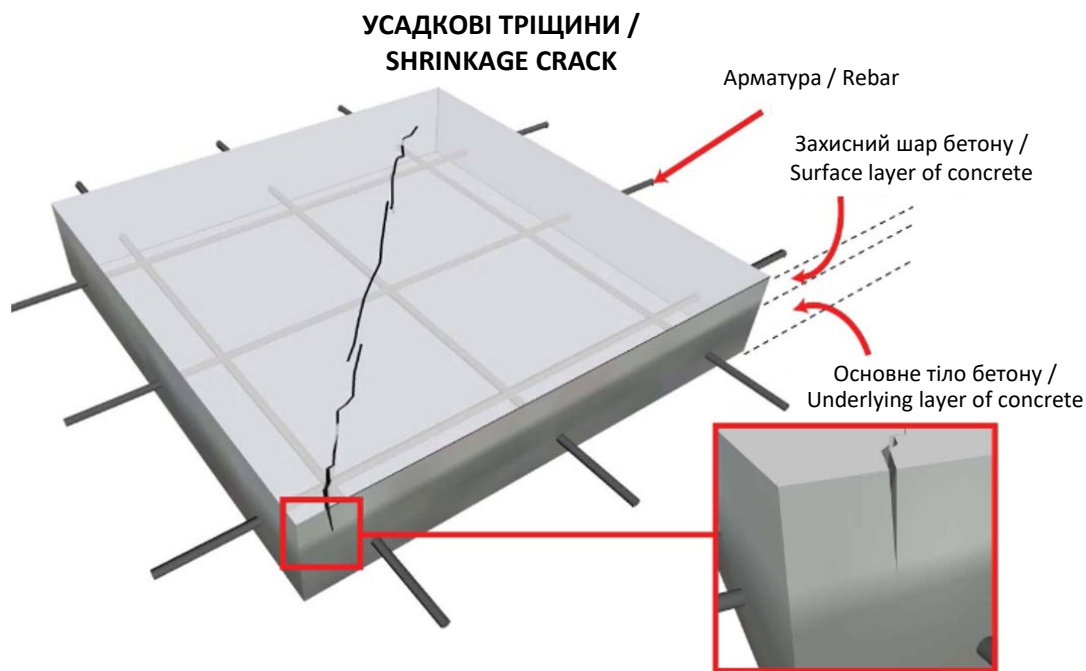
Усадочні тріщини в залізобетоні / Shrinkage cracks in reinforced concrete
